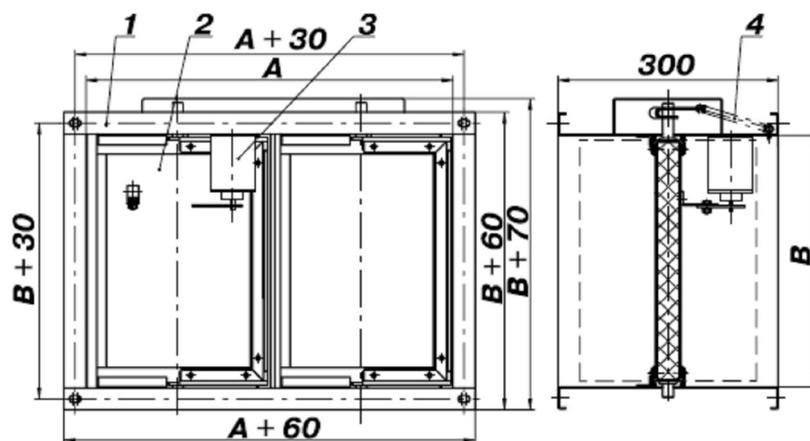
Прямоугольный клапан с электромагнитным приводом, установленным внутри: 1 – корпус; 2 – лопатка; 3 – электромагнит; 4 – пружина
